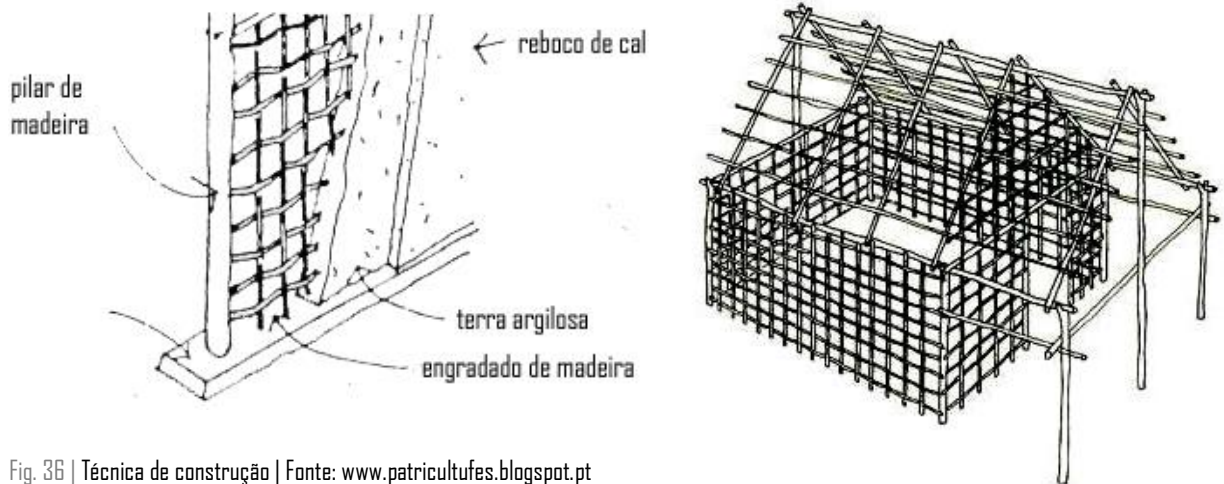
| Técnica de construção | Fonte: www.patricultufes.blogspot.pt
